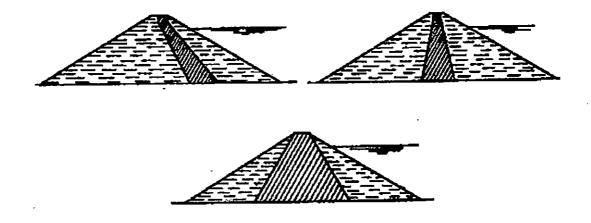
Algunas disposiciones esquemáticas típicas del corazón impermeable de una cortina de tierra.
